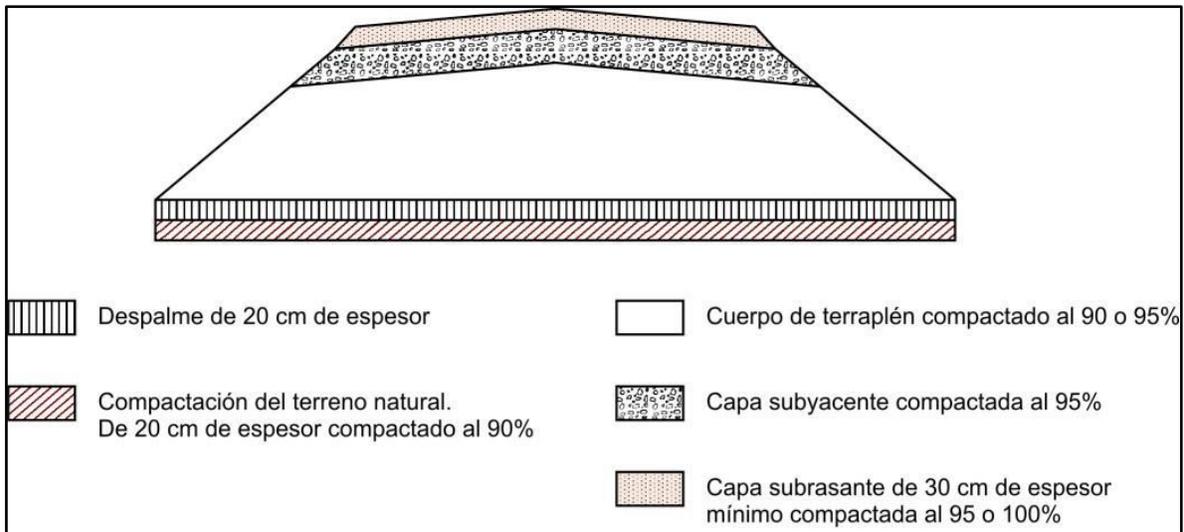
Ejemplo de croquis de procedimiento constructivo de una sección en terraplén.
